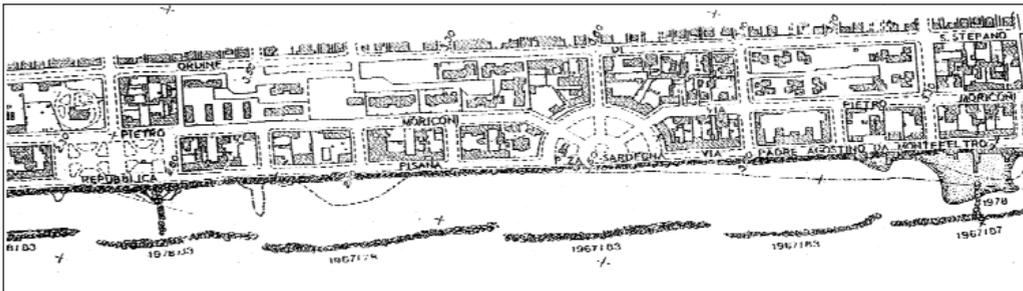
Pianta dello stato attuale delle opere di protezione.
